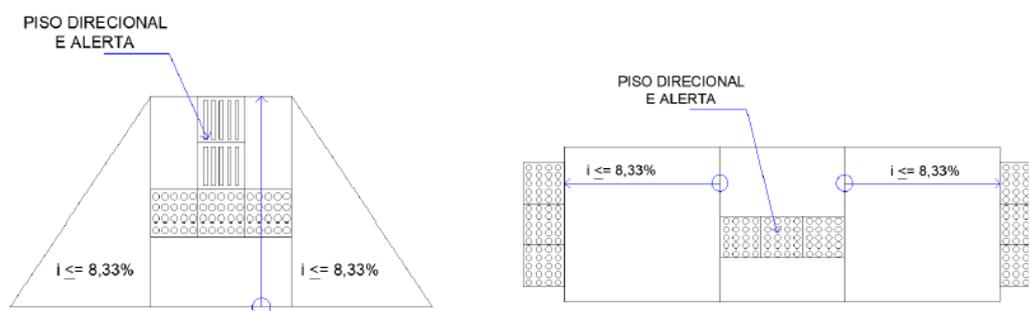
CORTE ESQUEMÁTICO REBAIXOS DE CALÇADA
